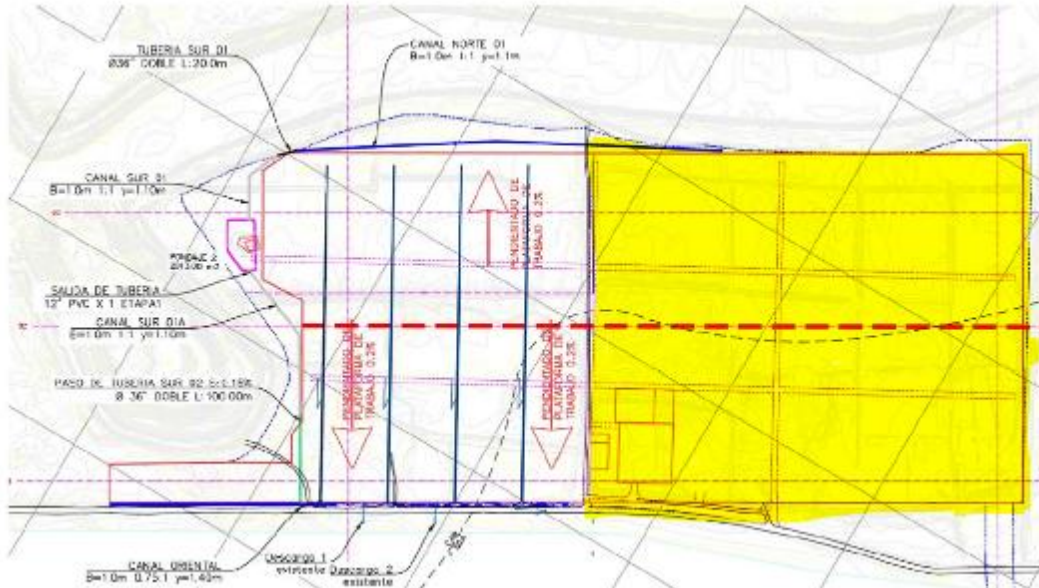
Localización de obras de drenaje en la plataforma en la etapa de construcción
